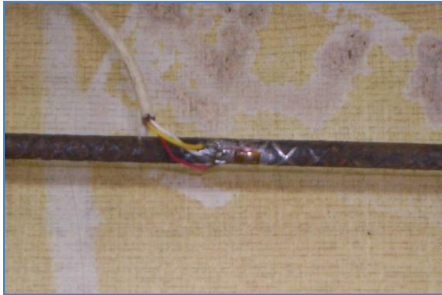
Colocación de deformímetros eléctricos tipo EA-06-250BG-120 en el acero de refuerzo.
